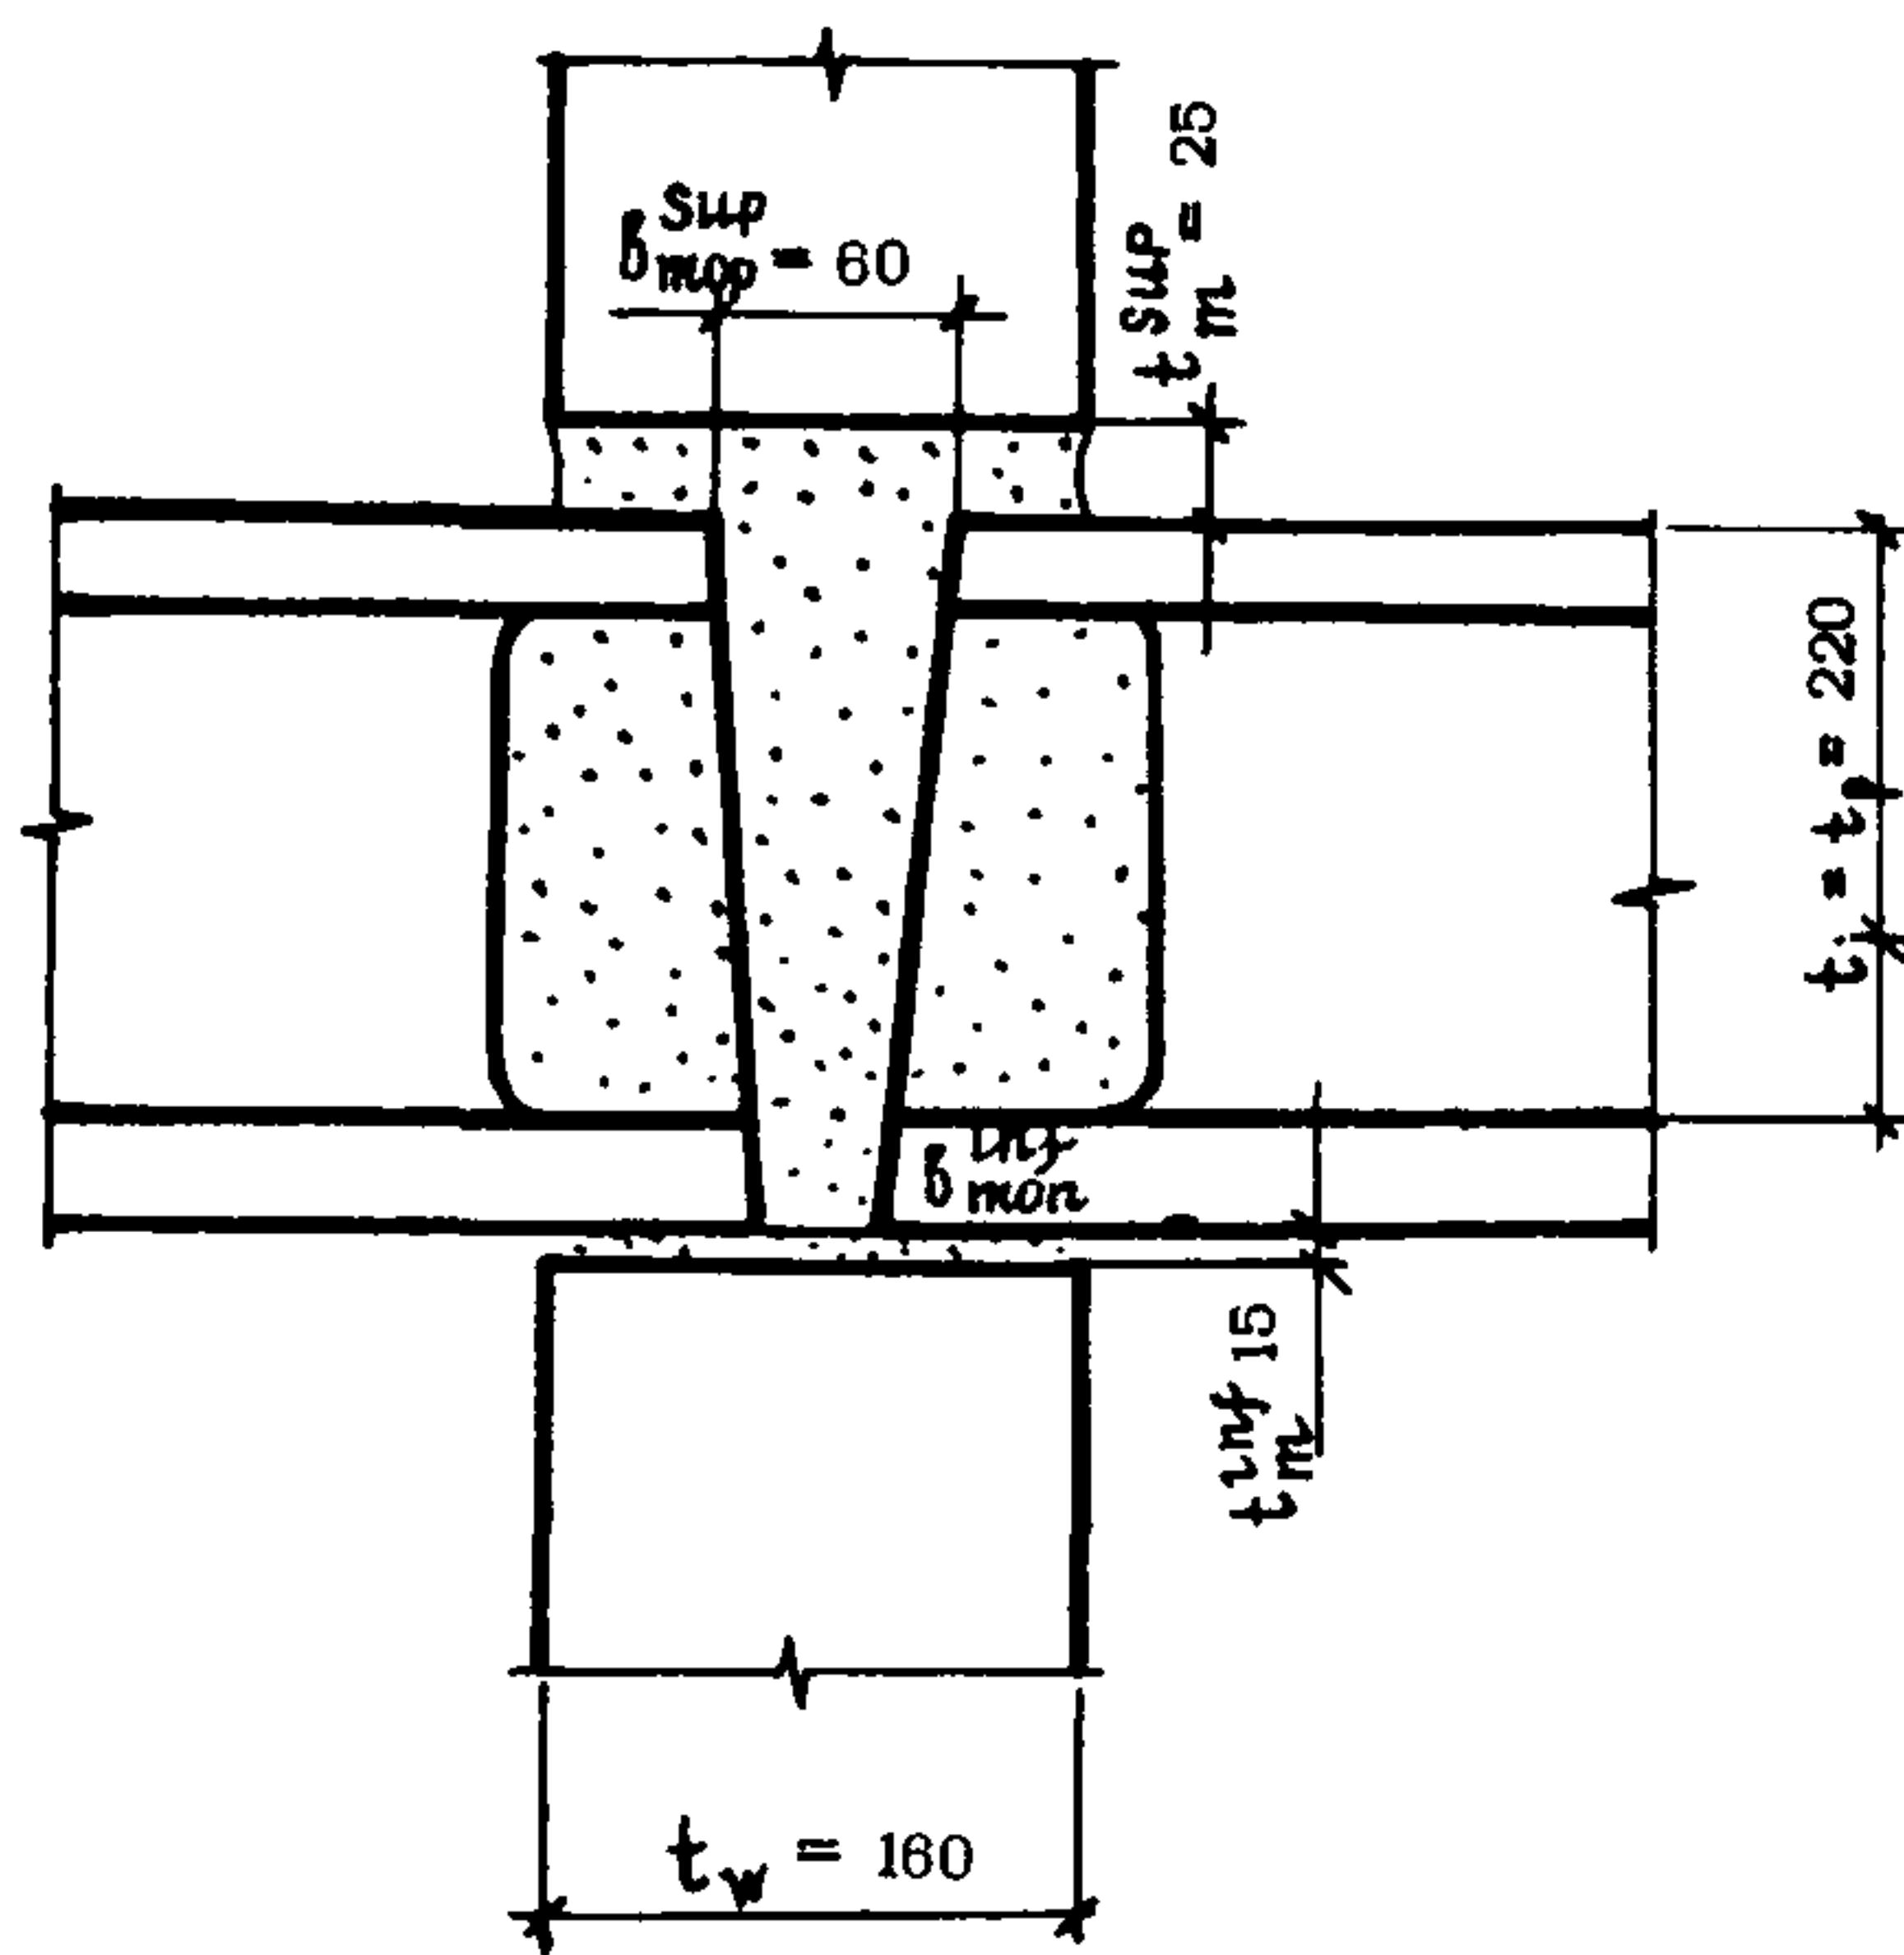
Платформенный монолитный стык внутренней панельной стены при двустороннем опирании плит перекрытий (к примеру 8)
